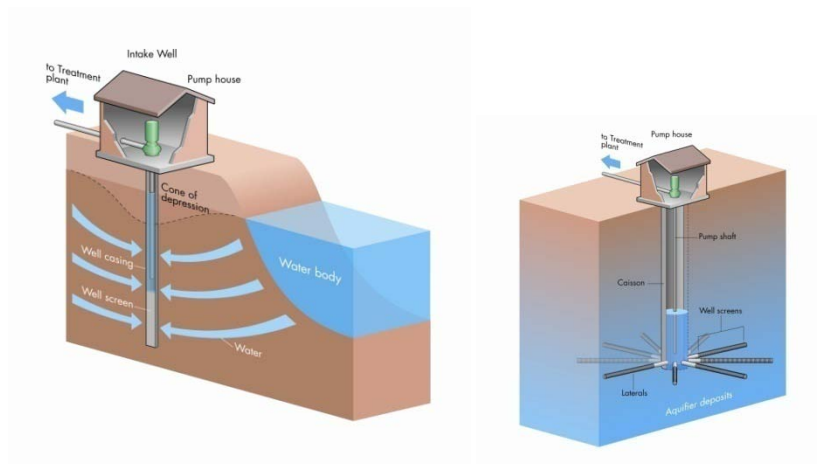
Pozos playeros para obra de toma de una planta desaladora
